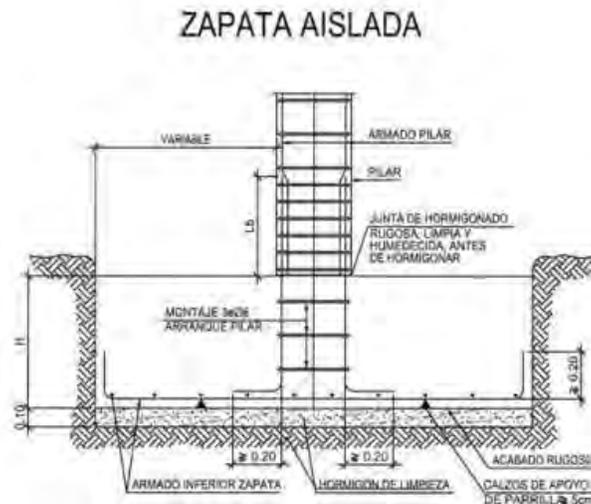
Detalle constructivo de una zapata aislada<sup>1</sup>
